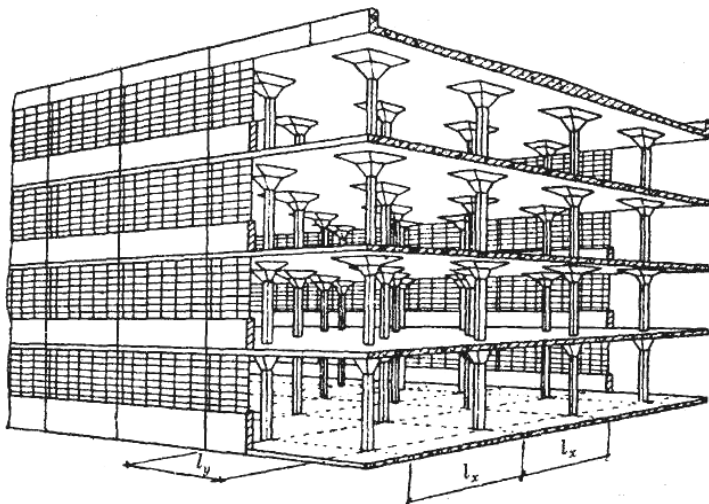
Многоэтажное здание с безбалочными перекрытиями
